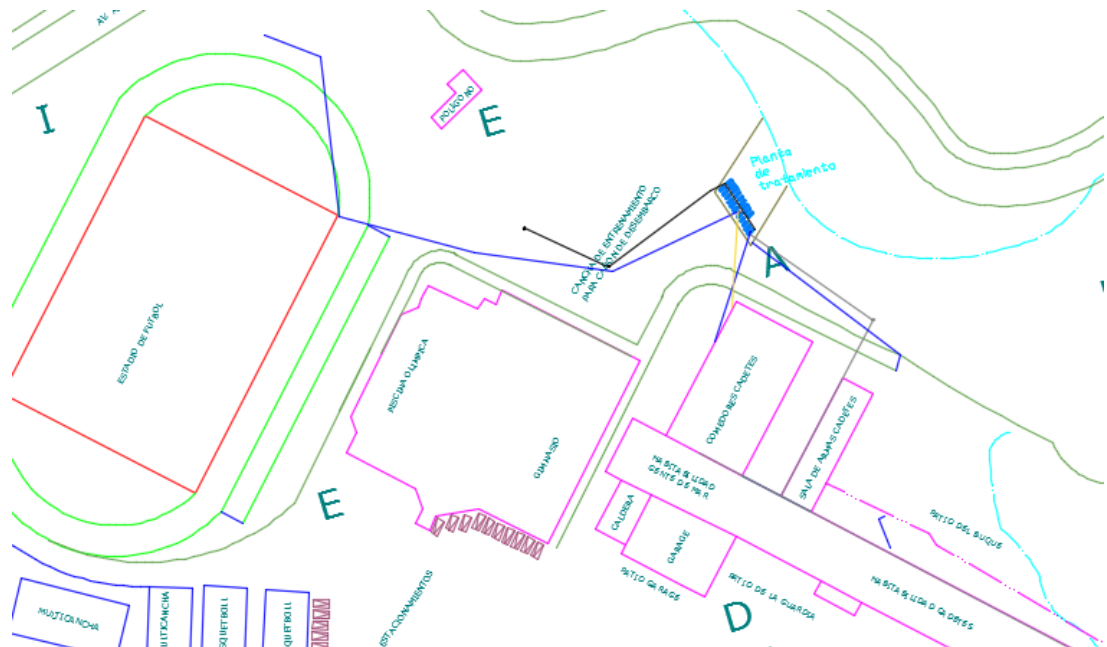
Ubicación de la Planta de tratamiento en la Escuela Naval
